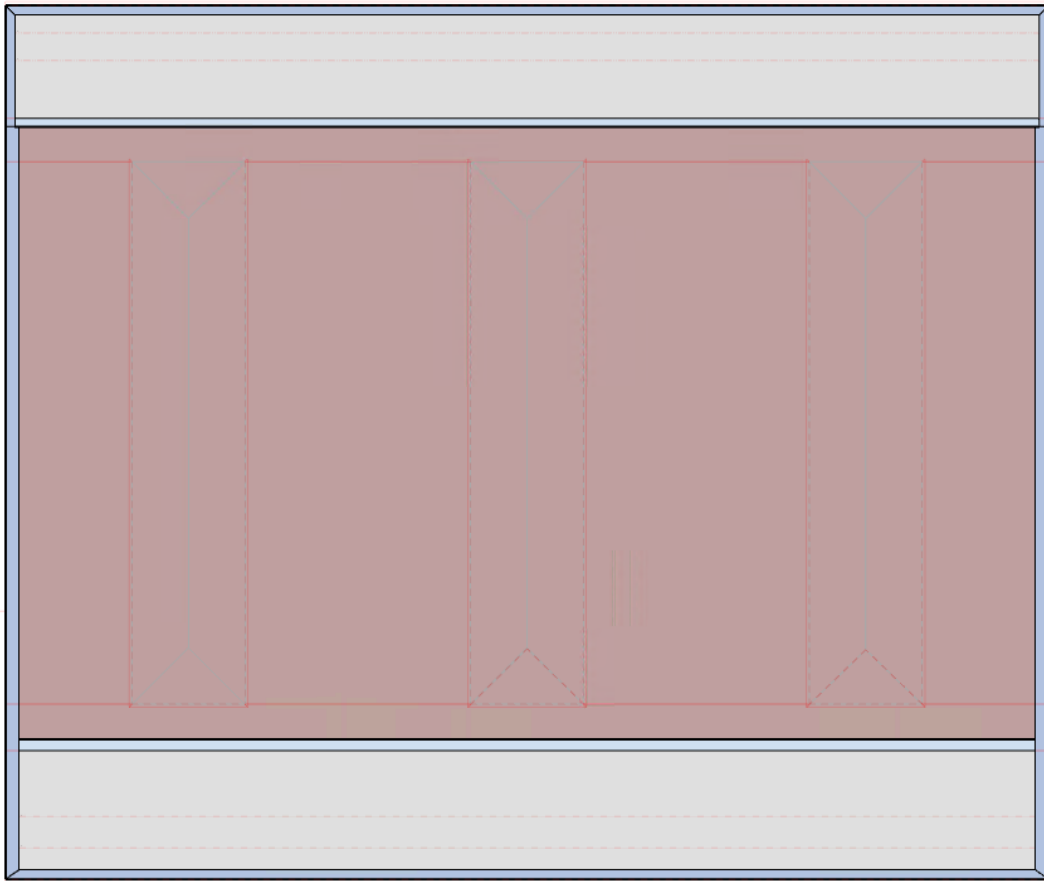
Grundriss 1.OG, zoniert
